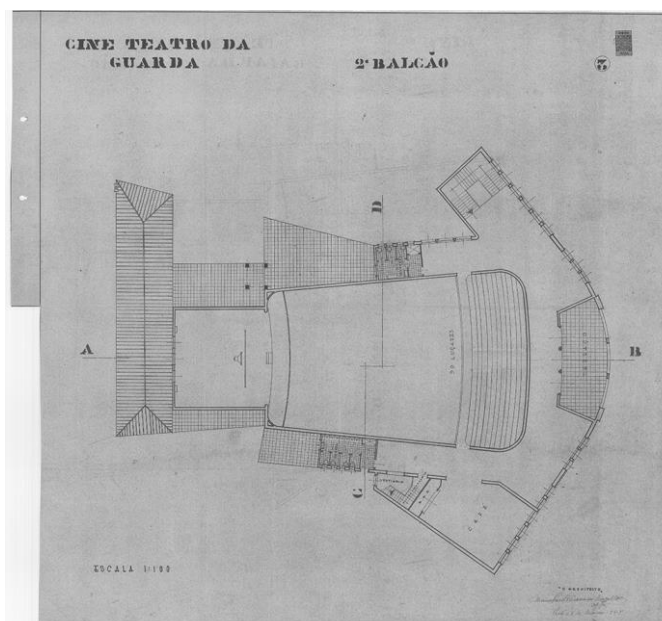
Cineteatro da Guarda, Planta nível do 2º Balcão
